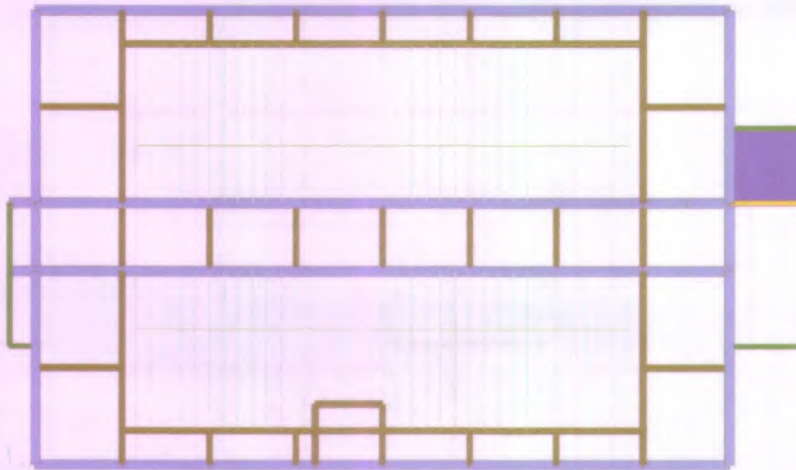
Denah pembalokan lantai 2 [+4.00]
